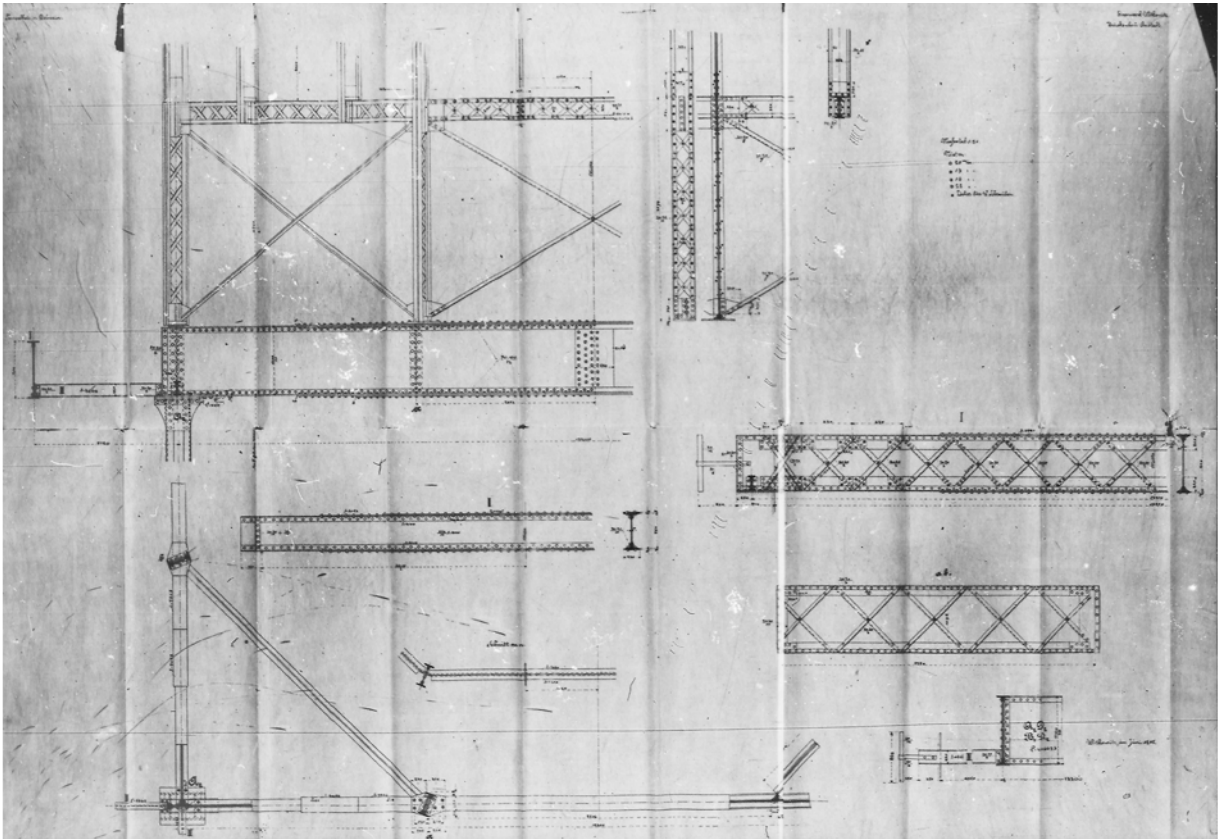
Stahlkonstruktion Kuppel Detail 01
